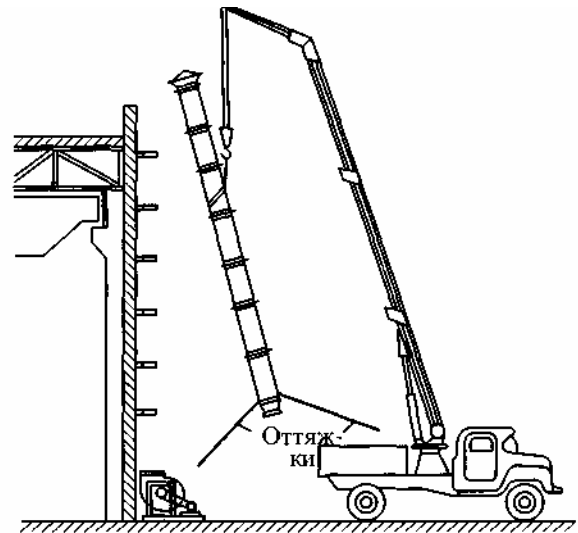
Монтаж вертикальных воздуховодов на наружной стене здания автомобильным краном
